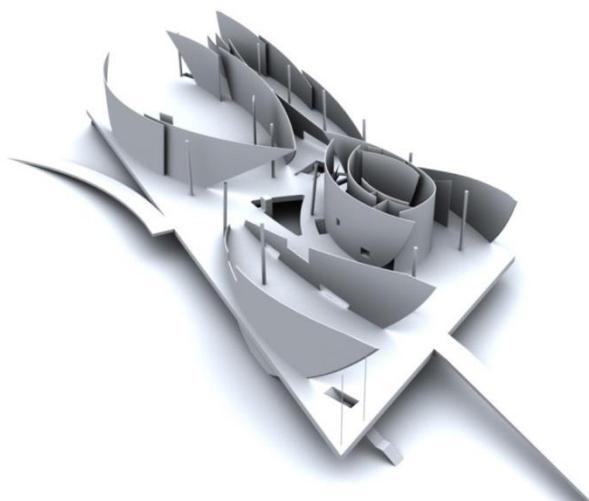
Vista Interna. Fonte: archdaily.com.br.
